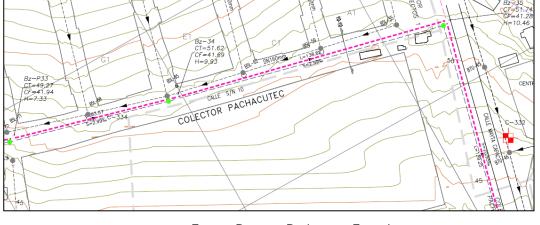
Tramo profundo Colector Pachacutec - Vista en planta
